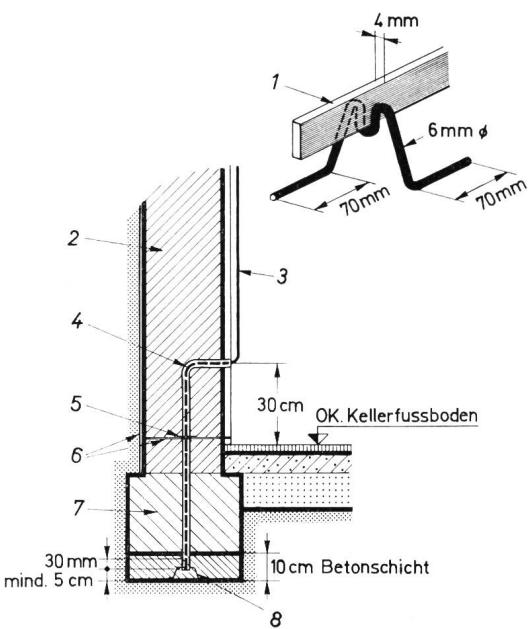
Fundament aus Stampfbeton oder bewehrtem Beton
